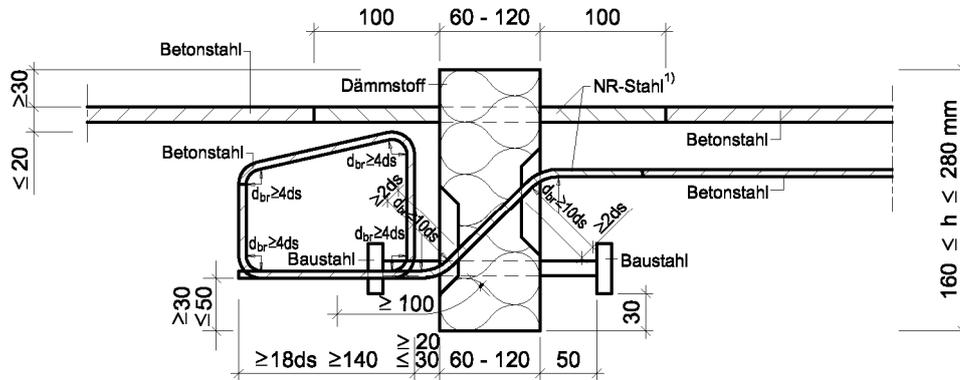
Schöck Isokorb Typ KX¹⁾ mit Druck- Querkraft Kombination und integrierter Aufhängebewehrung.
